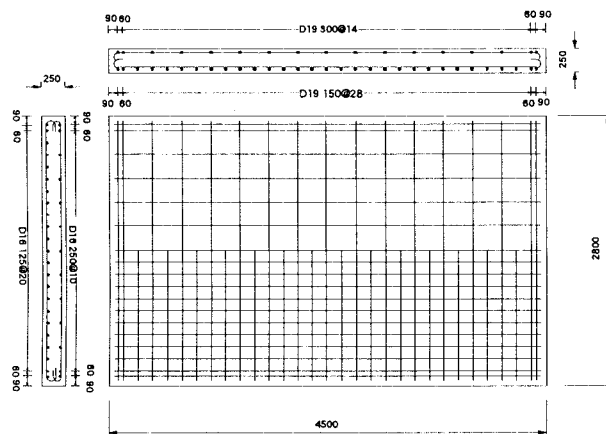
RC 8n 供試体の形状・寸法 (単位: mm)
